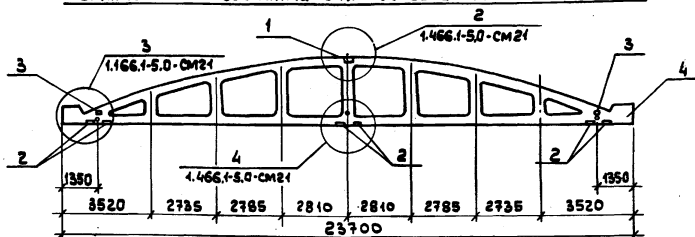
Доработка чертежей фермы ФКБ18-3AV-а с дополнительными закладными изделиями для подвески краёв по схеме 1
